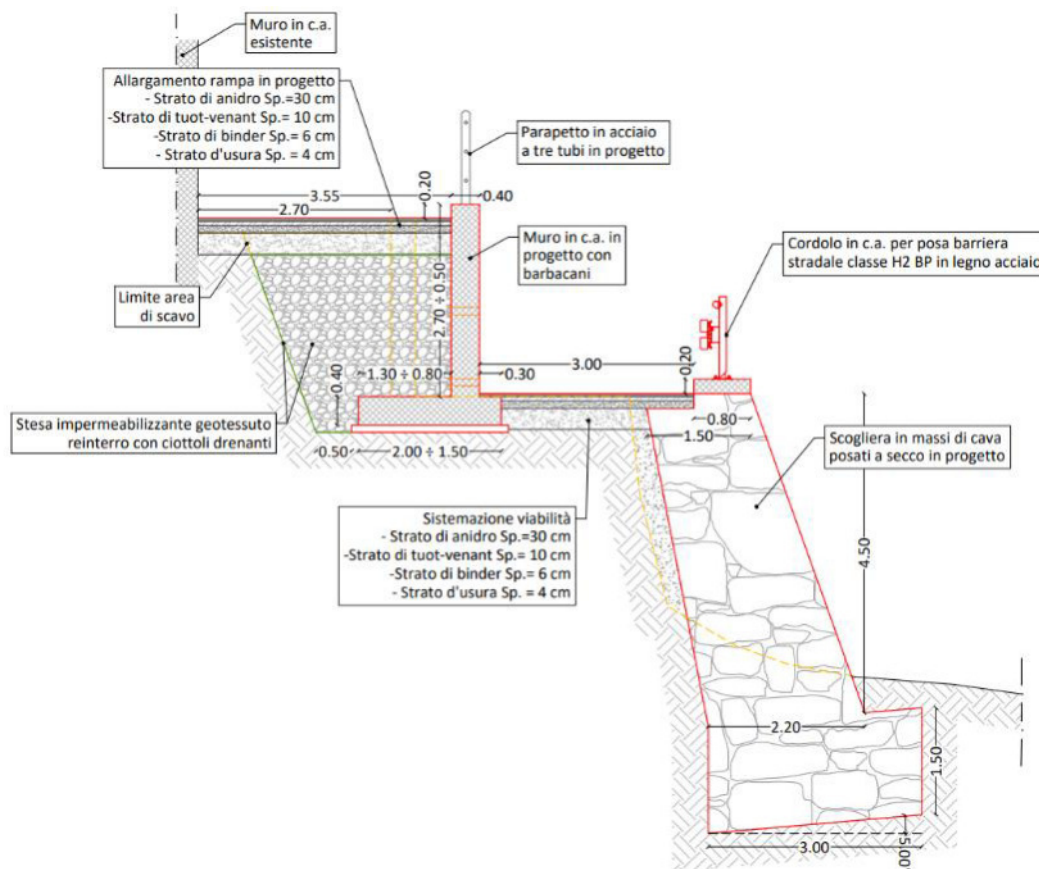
Sezione tipo muro in c.a. e scogliera – intervento 9.
